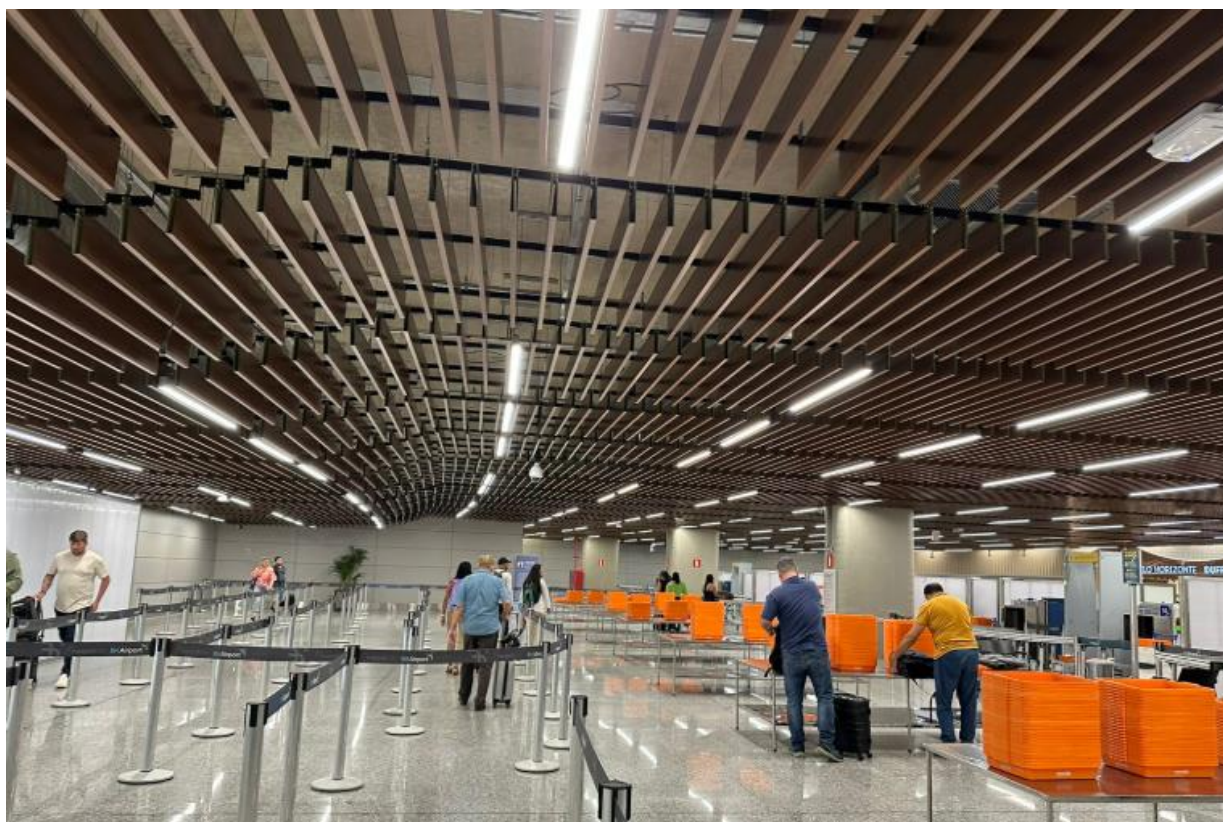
Exemplo de forro baffle amadeirado aplicado de forma ondulada
